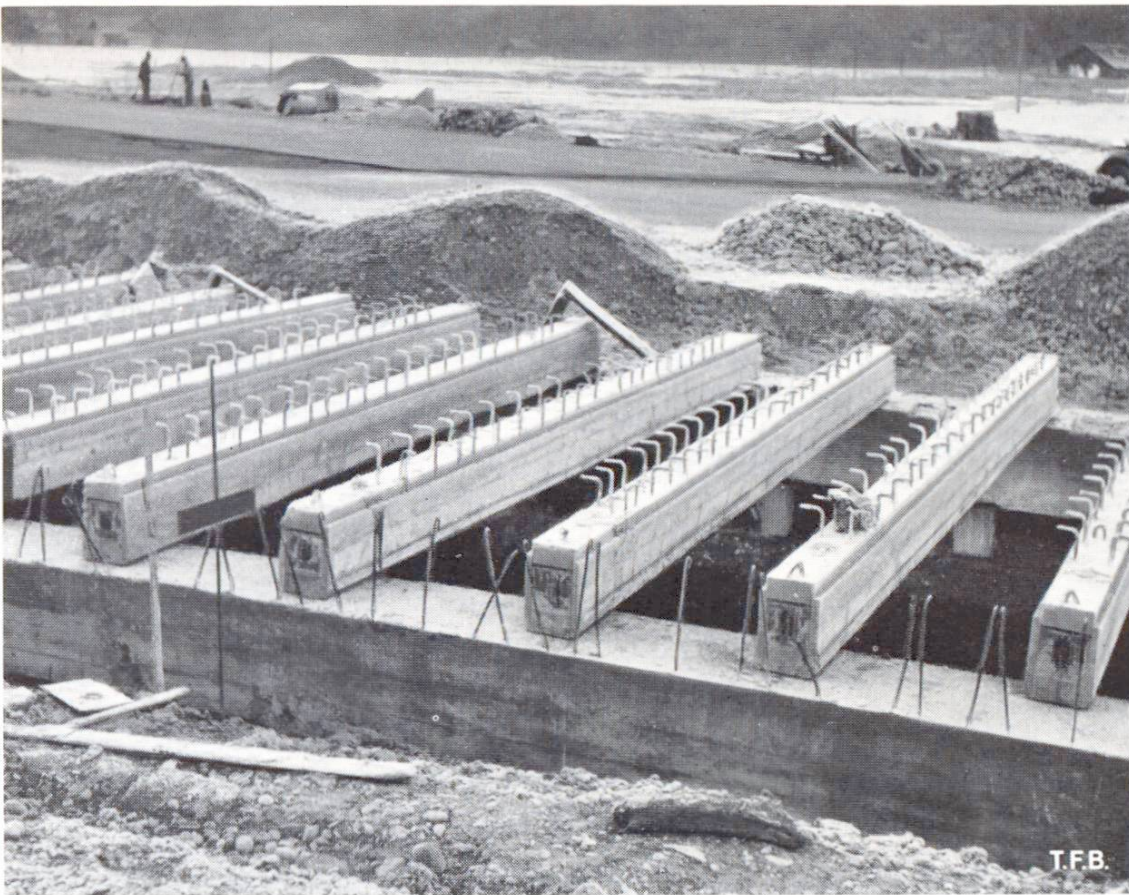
Bachüberdeckung mit vorfabrizierten vorgespannten Betonbalken. Spannweite 6 m
